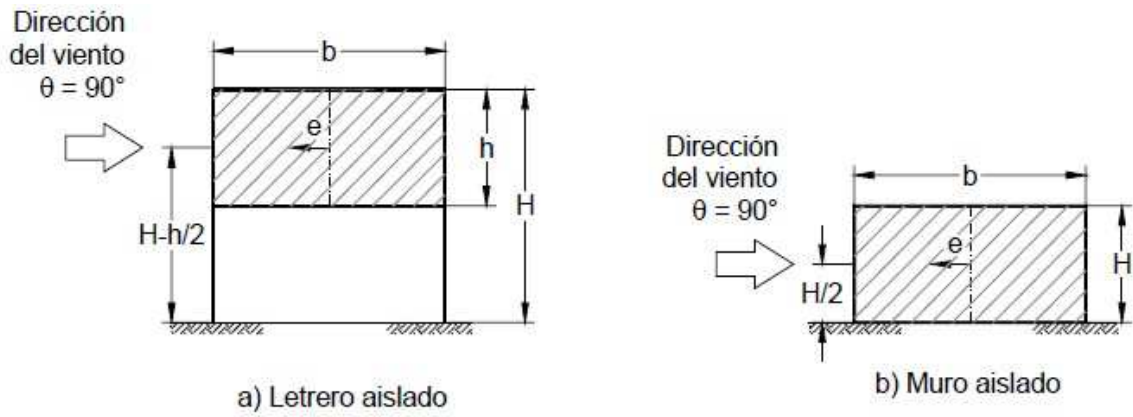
Estructura tipo letreros aislado o muros aislado "espectaculares" (CFE, 2008b).
